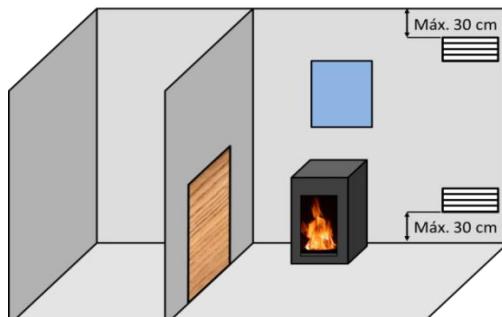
Schéma indicatif pour les grilles de ventilation
